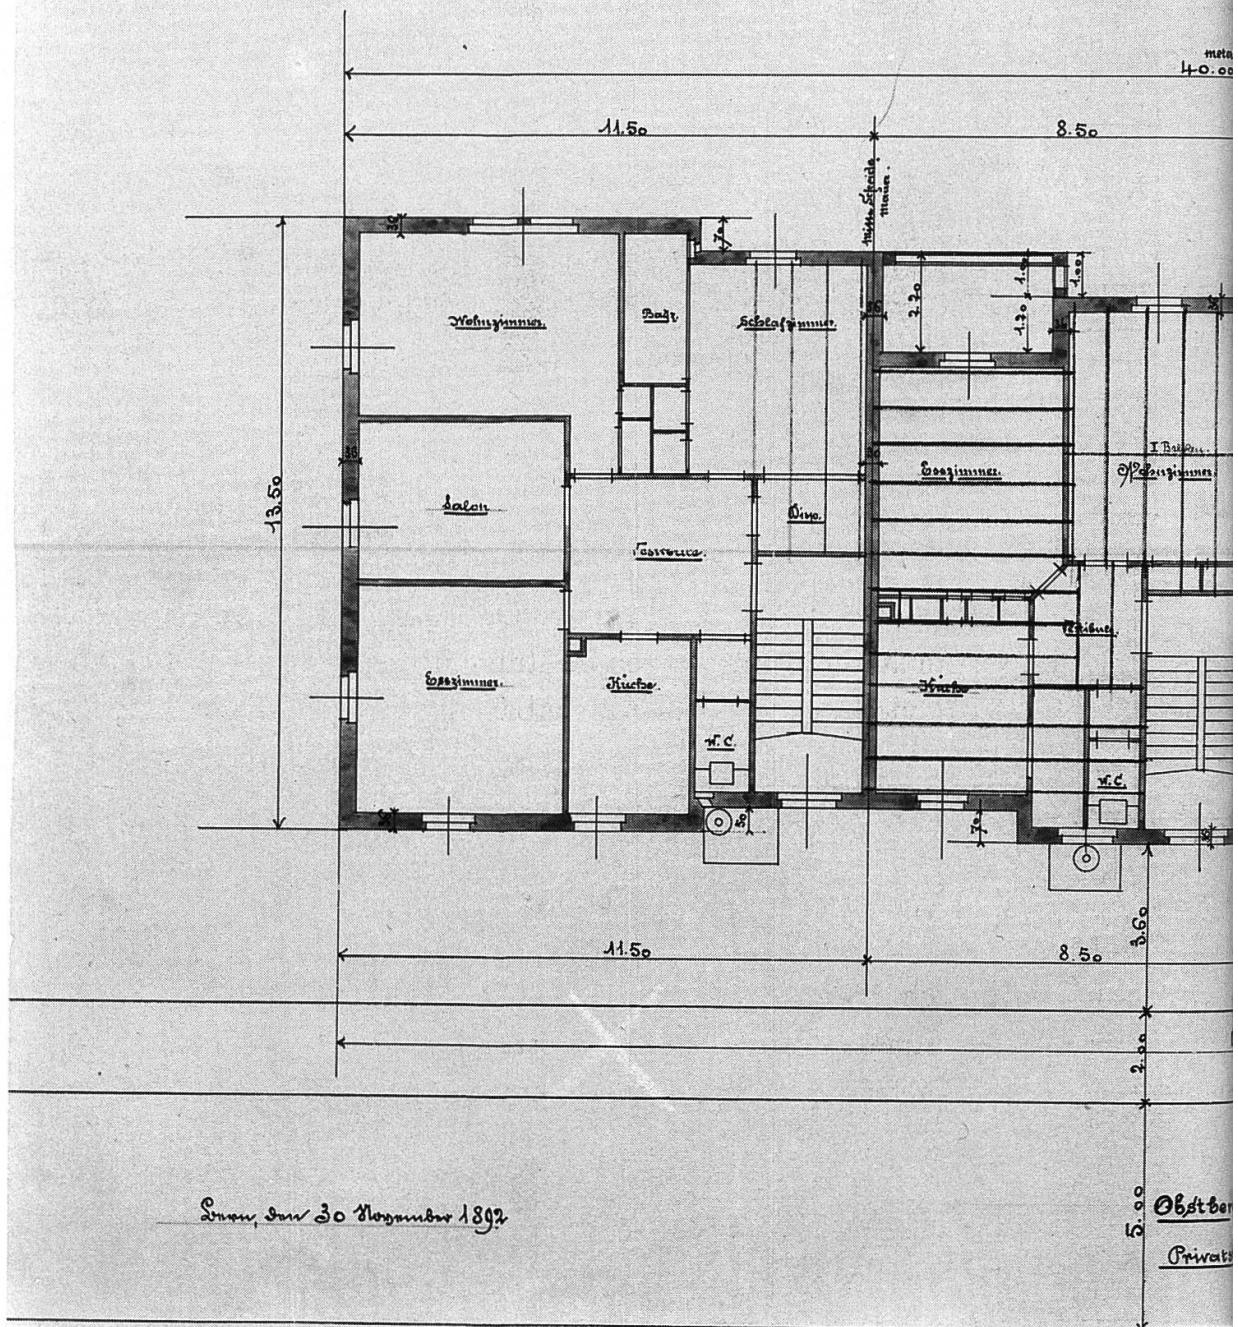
Obstbergweg 4-14. Grundriss von 1893.
